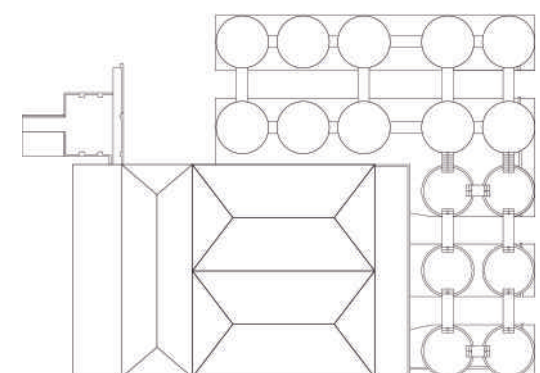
Planta Nivel 1 Esc. 1 a 750
